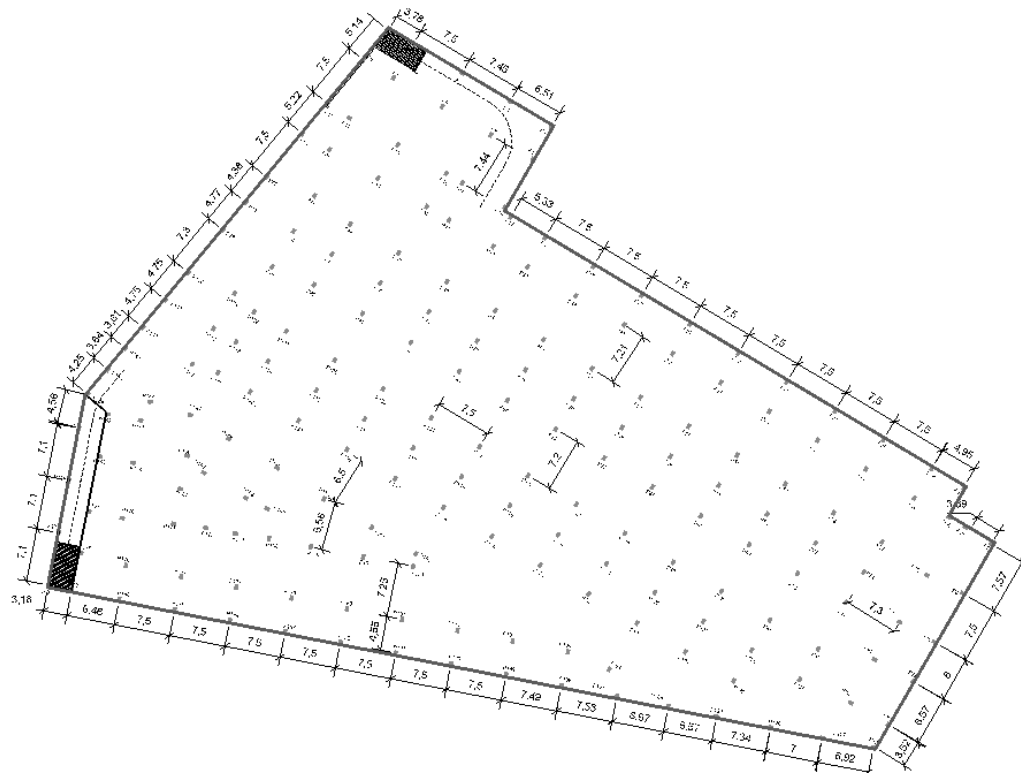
"DISTRIBUCIÓN EN PLANTA DE LOS PILARES."
